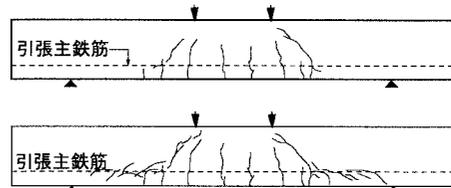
ひび割れ状況（上：①時点、下：②時点）
